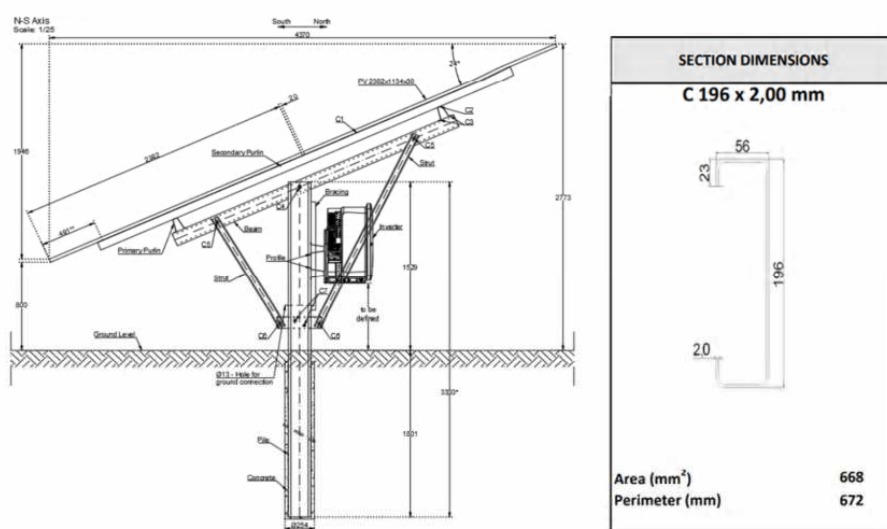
Coupe transversale d'un panneau et profil d'un pieu
